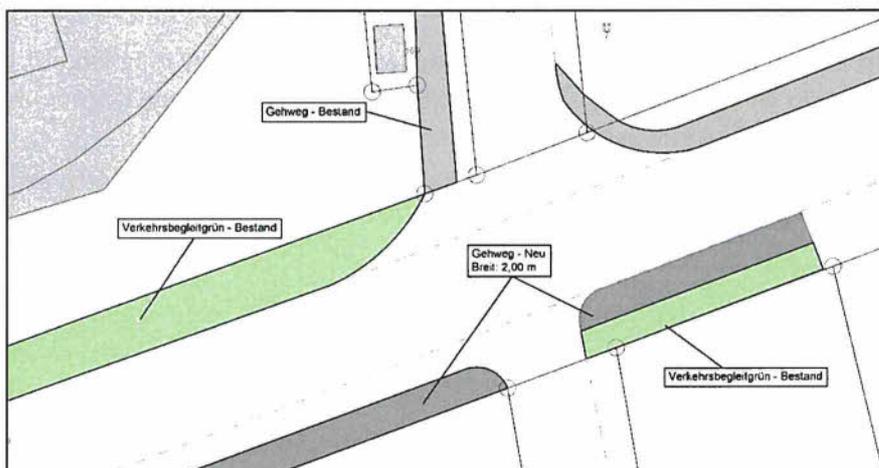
geplante fußläufige Erschließung des Plangebietes
